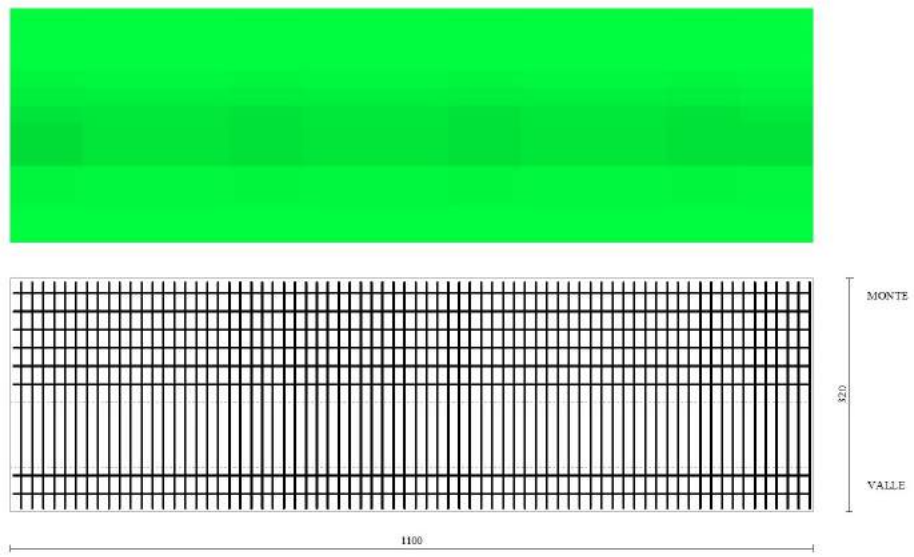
Piastra fondazione dir. Y (Inviluppo)
